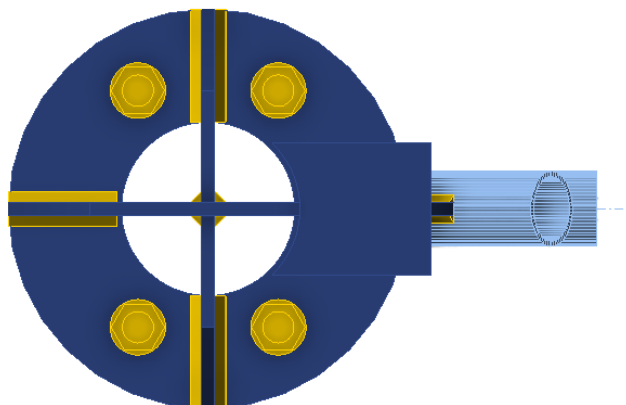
Розріз монтажного стику нижнього поясу просторового блоку ферми
